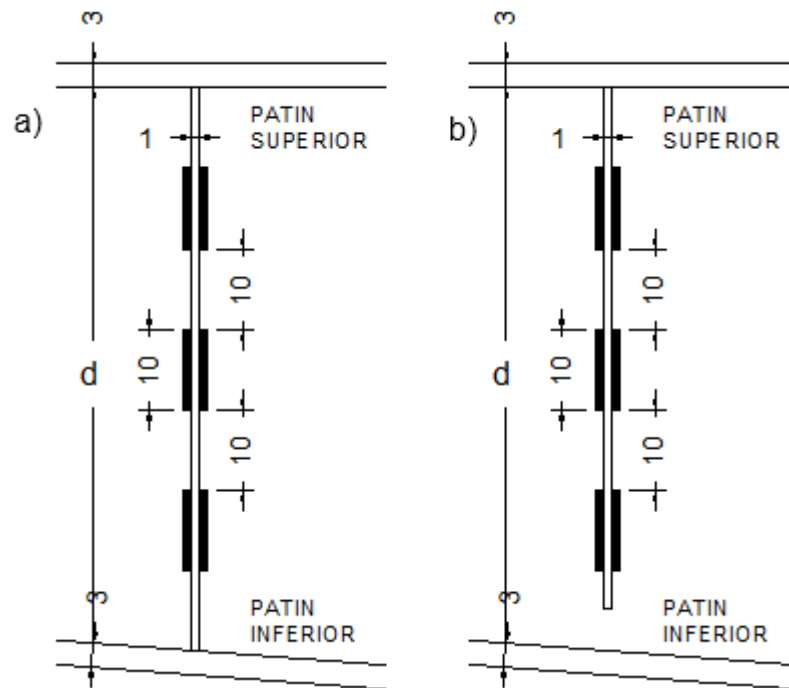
Ubicación del cordón de soldadura entre el rigidizador transversal y el alma de viga (a). Ubicación del cordón de soldadura entre el rigidizador transversal intermedio y el alma de viga (b) (vista lateral)
